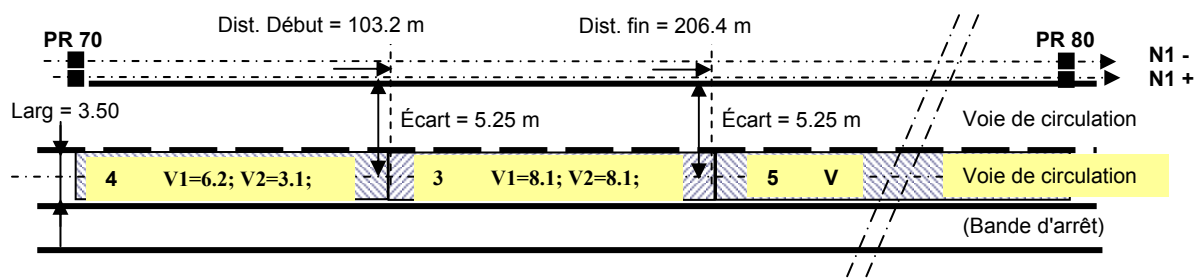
Exemple de relevés de la planéité transversale (T) en mm sur la voie normale
